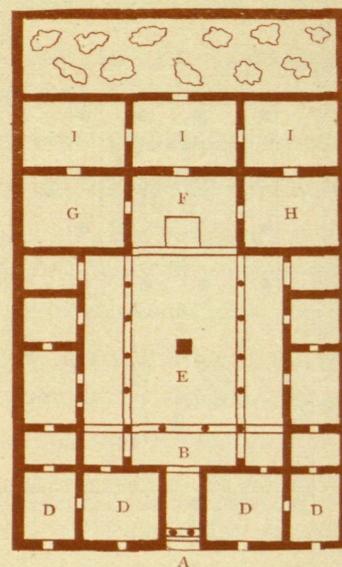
PLANTA DE UNA CASA HELÉNICA CON UN PERISTILO
